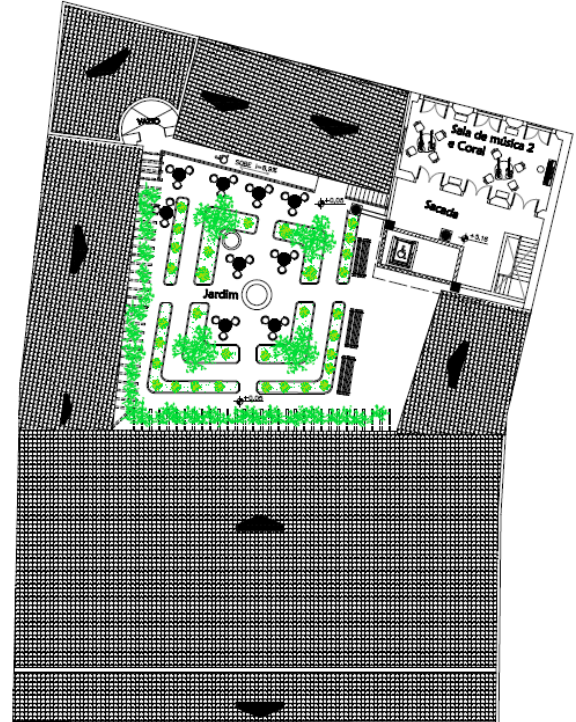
Proposta de uso - Planta-baixa 1º Pav. bloco 2
